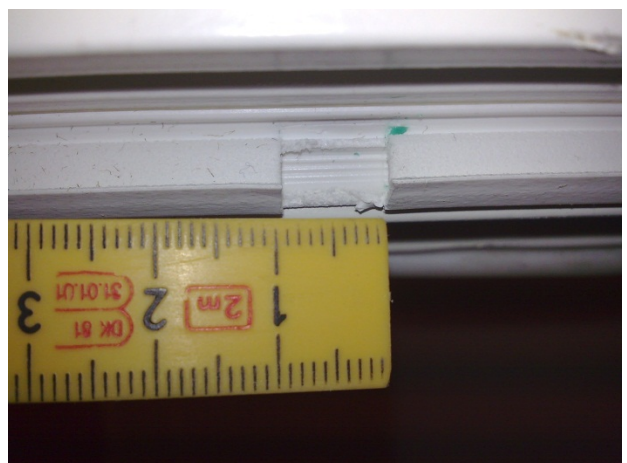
Vindu L1. Nærbilde 10 mm utsparring
